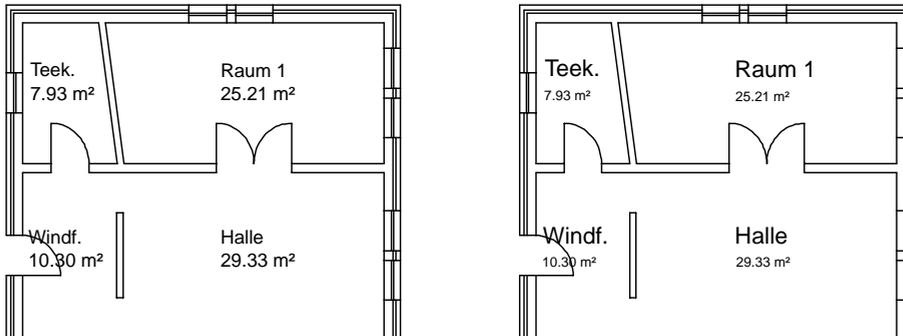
Grundriss mit Raumbezeichnung und Flächen vor / nach Änderung
